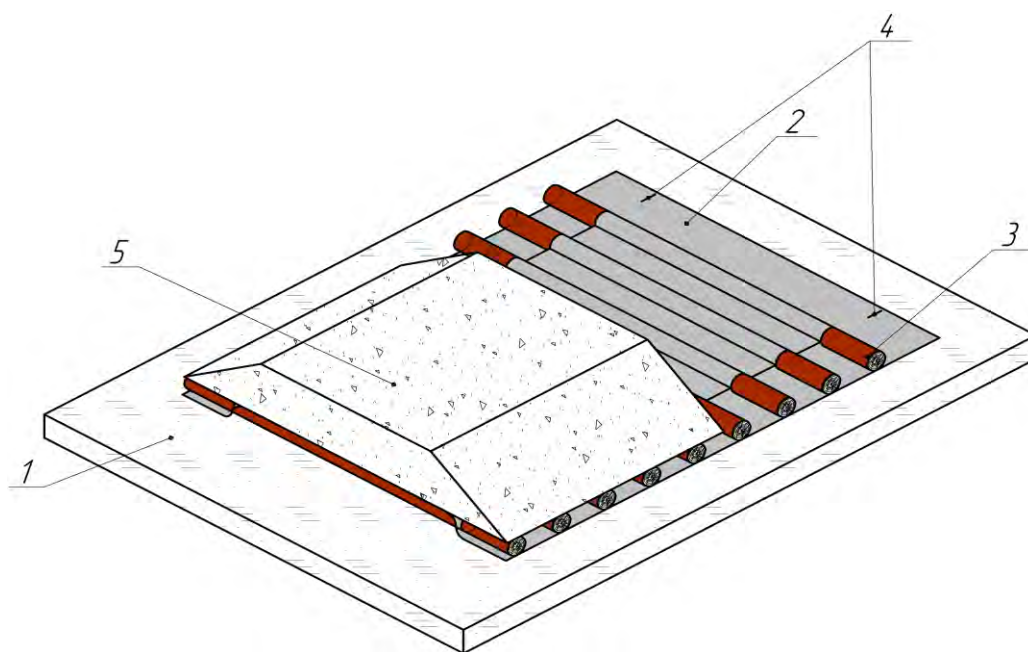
Насыпи с геотекстильной прослойкой и разреженным настилом:
